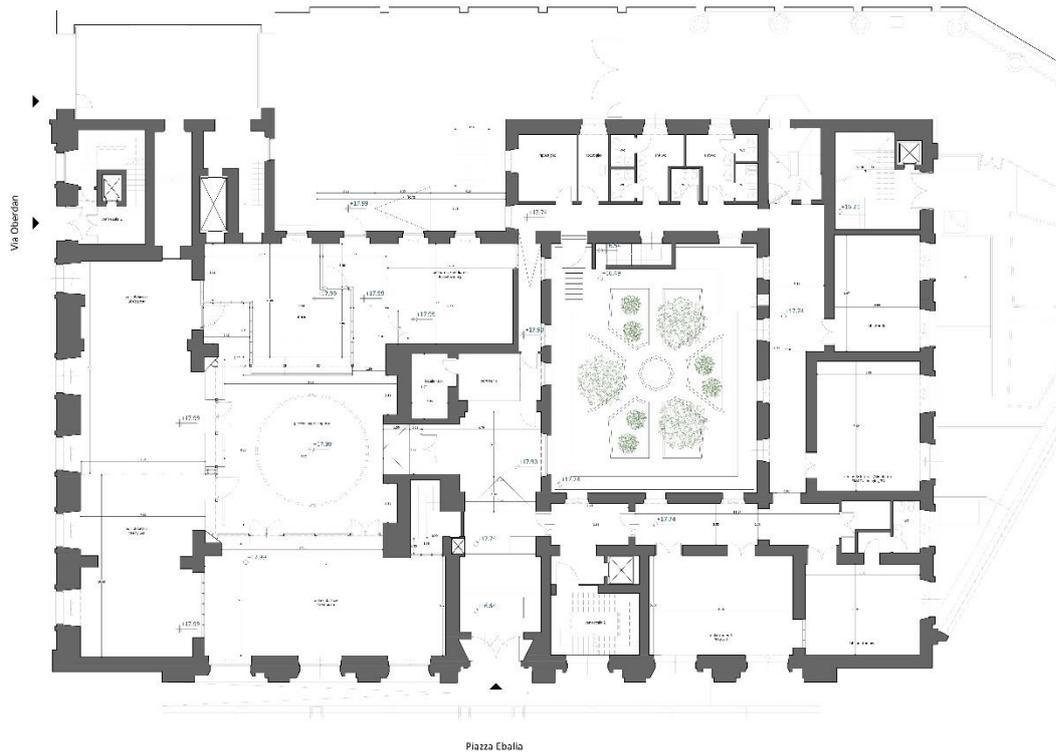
Pianta piano rialzato. Progetto a cura di ASSET Puglia
